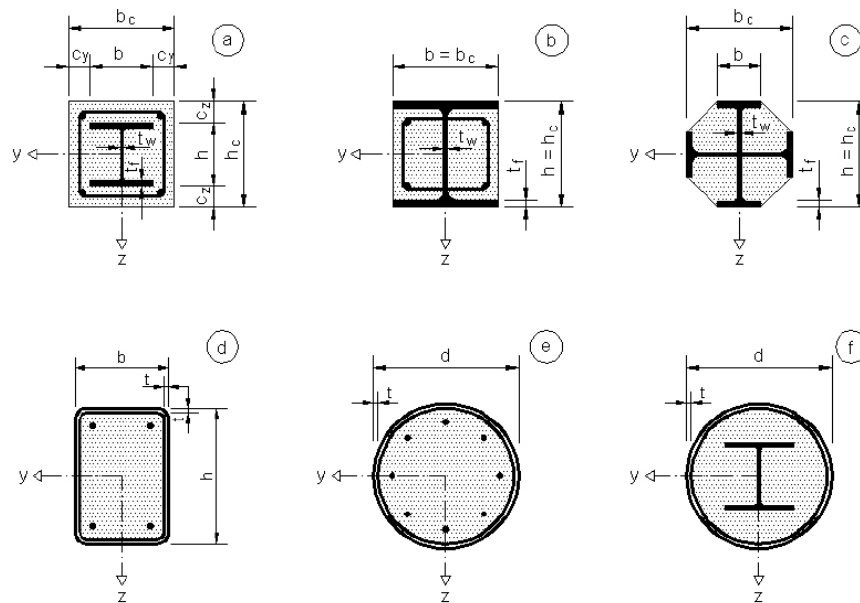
Secções transversais típicas de pilares mistos aço-betão (retirado de [1])
